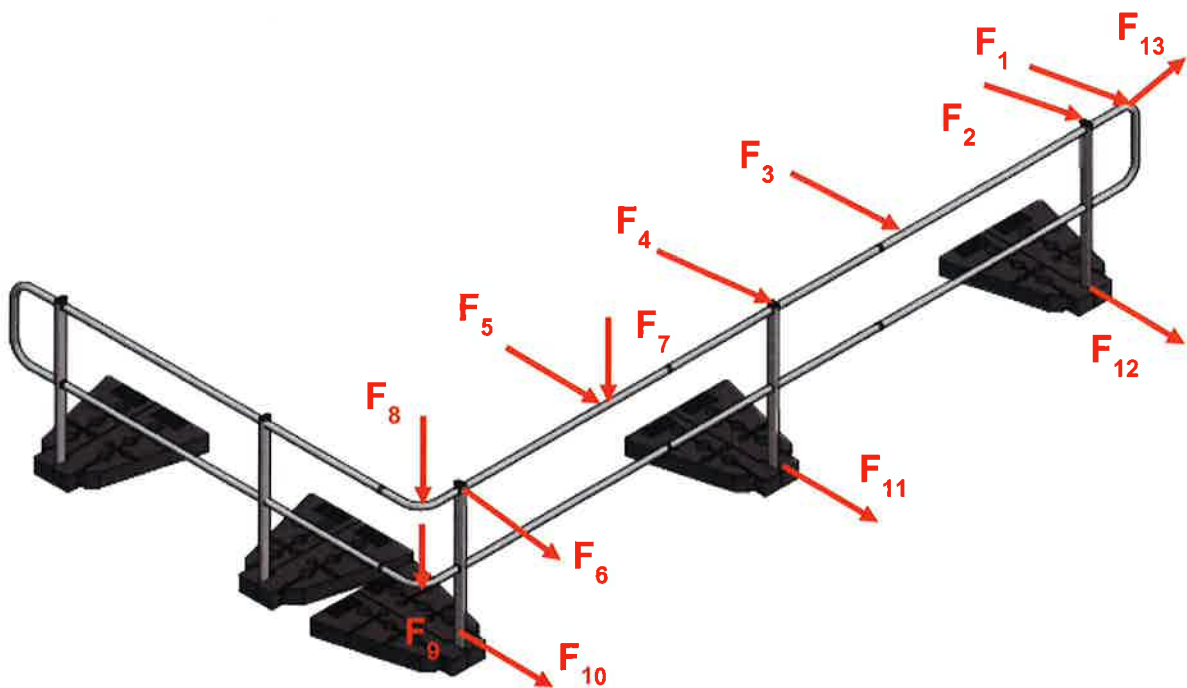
Prüfaufbau 2 mit den Richtungen und den Positionen der Kräfteinleitungen
